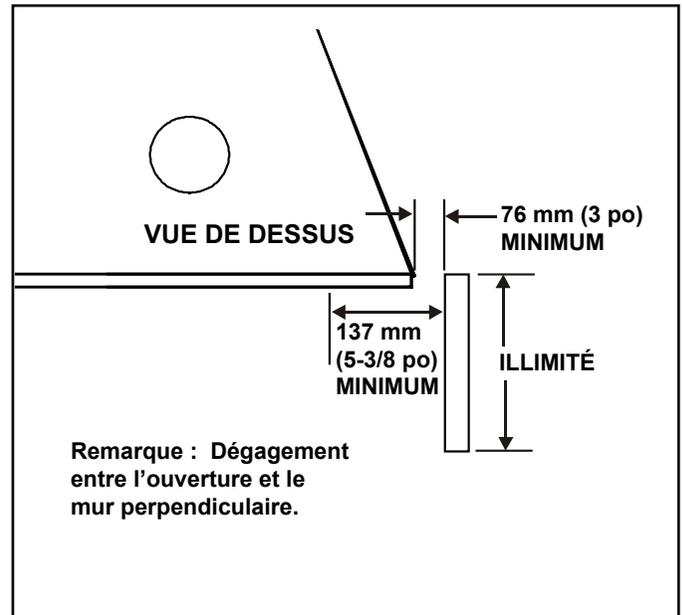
Dégagements du pied du manteau du foyer ou saillie du mur (acceptable de part et d'autre de l'ouverture)
